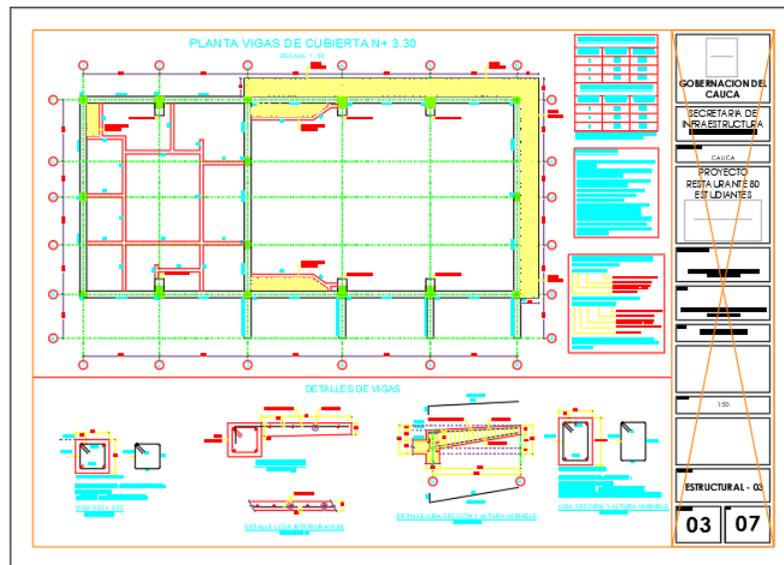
Plano estructural de cubierta Restaurantes escolares. Fuente: Ing. Diego Ricardo
